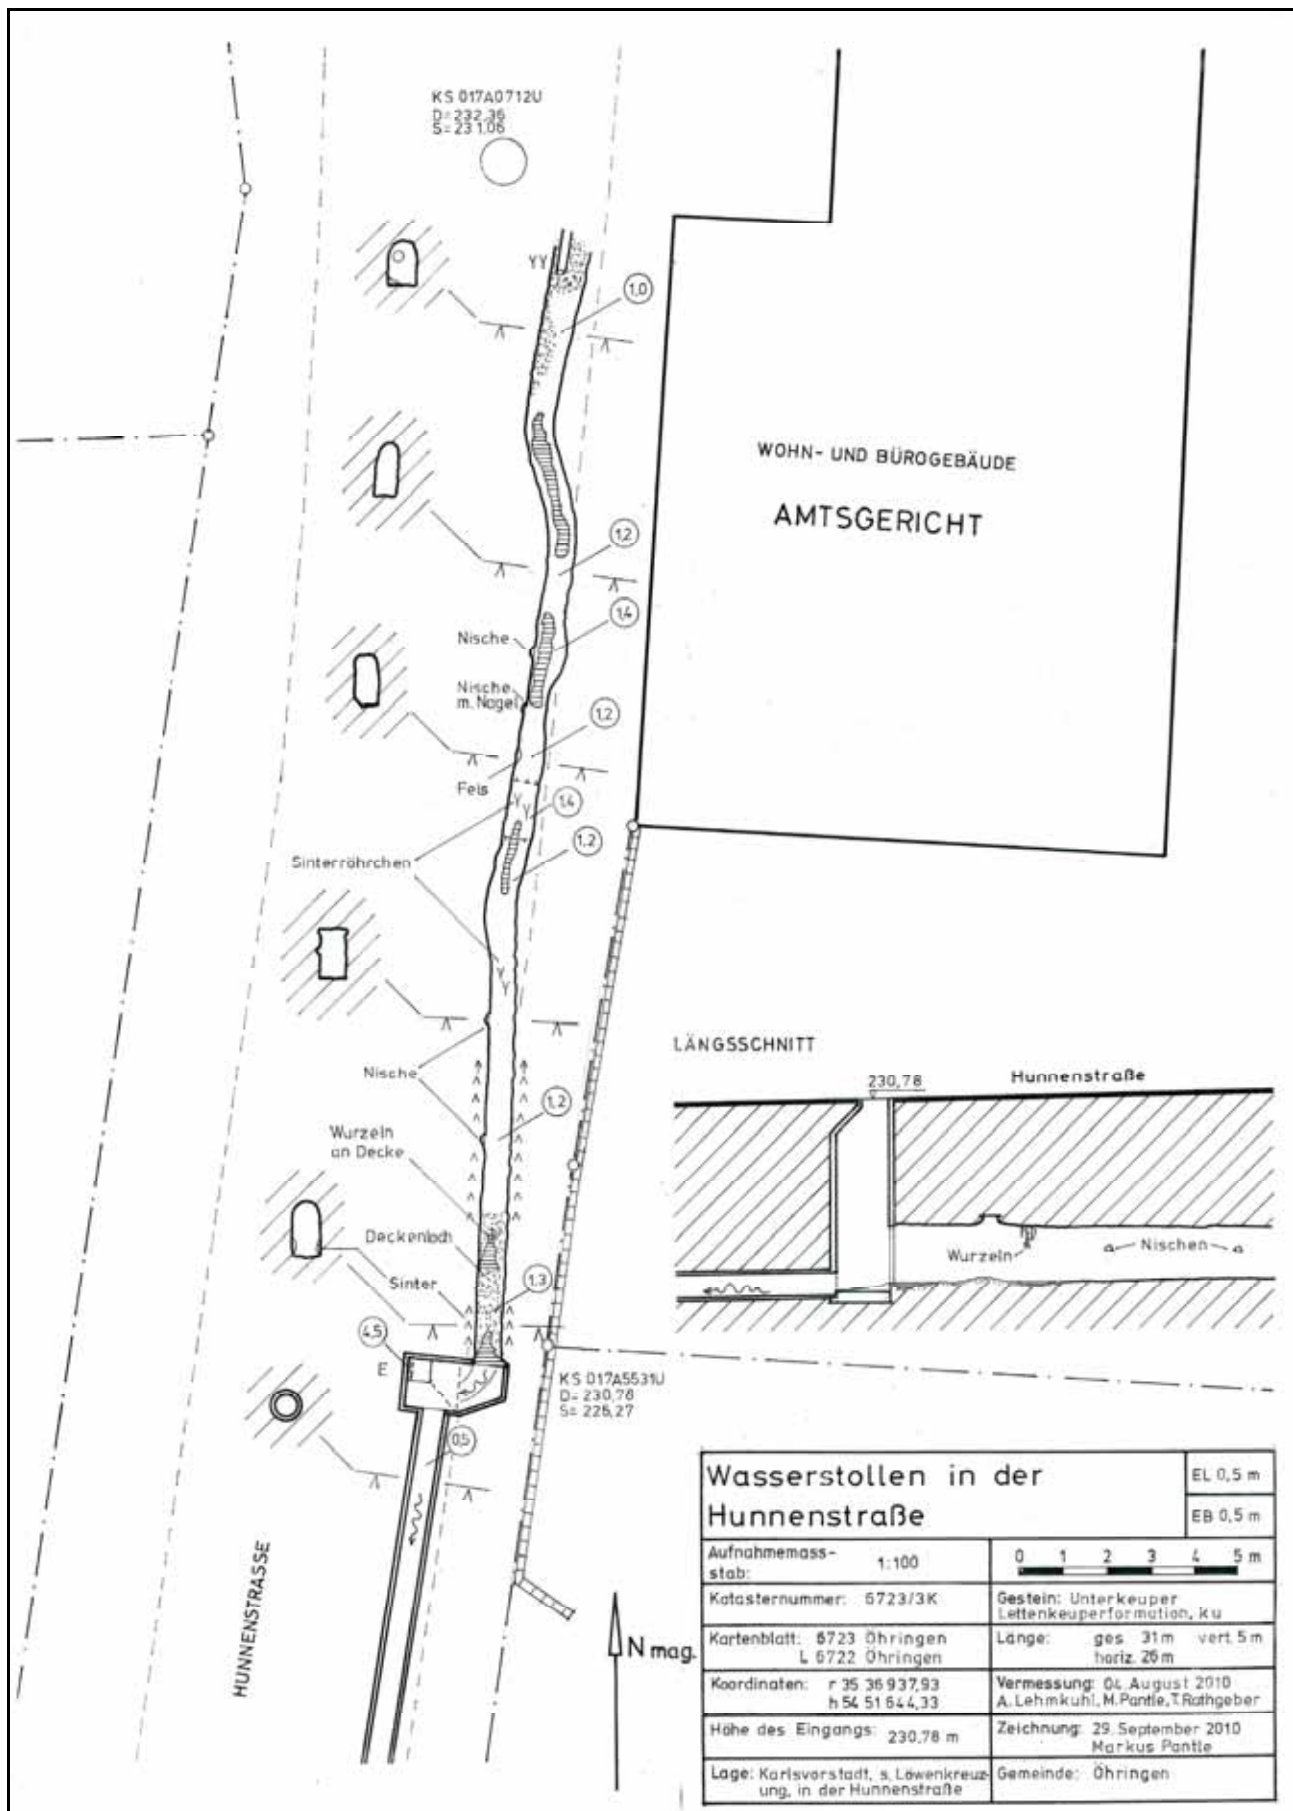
Plan des Wasserstollens in der Hunnenstraße (6723/3K) – Darstellung in Grundriss, Längsschnitt im Eingangsbereich und 5 Profilen (Zeichnung M. Pantle).
